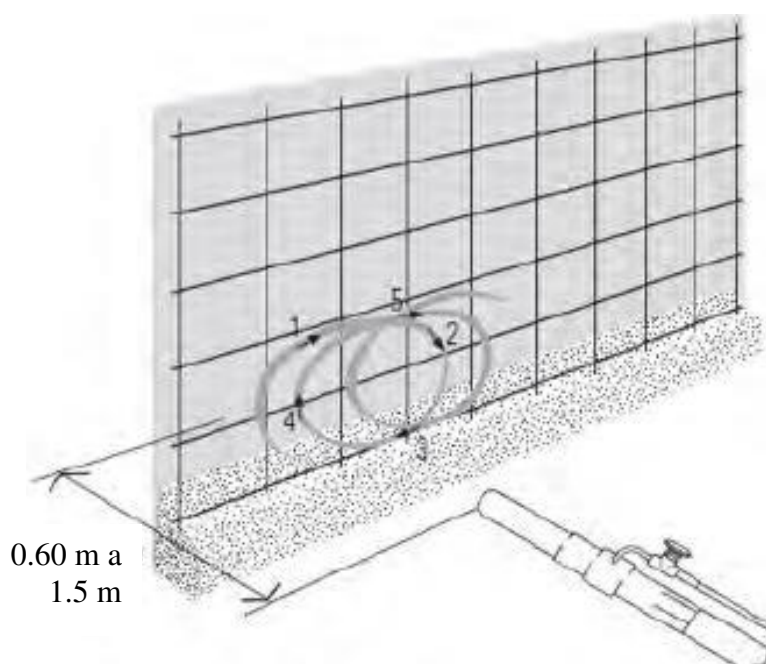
Aplicación de concreto lanzado. Fuente: (Instituto del Cemento y del Hormigón de Chile)
